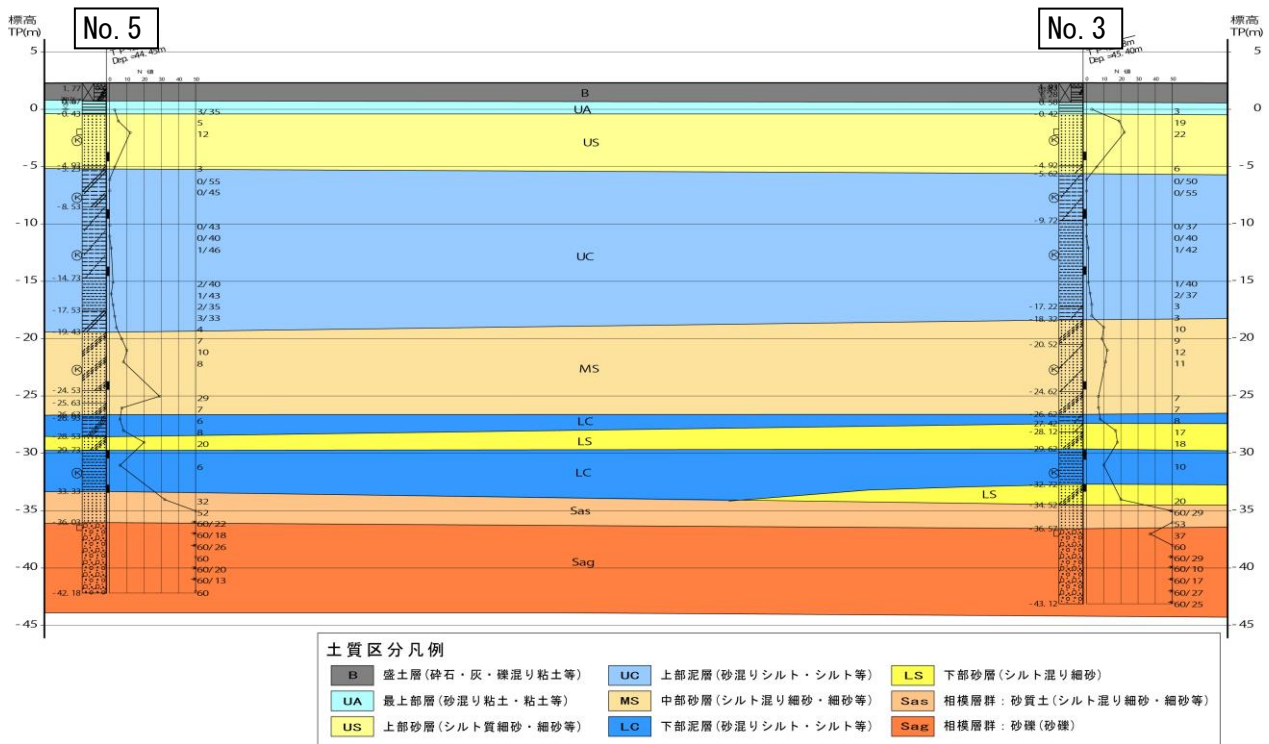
(3) 想定地質断面図 (断面 3)
